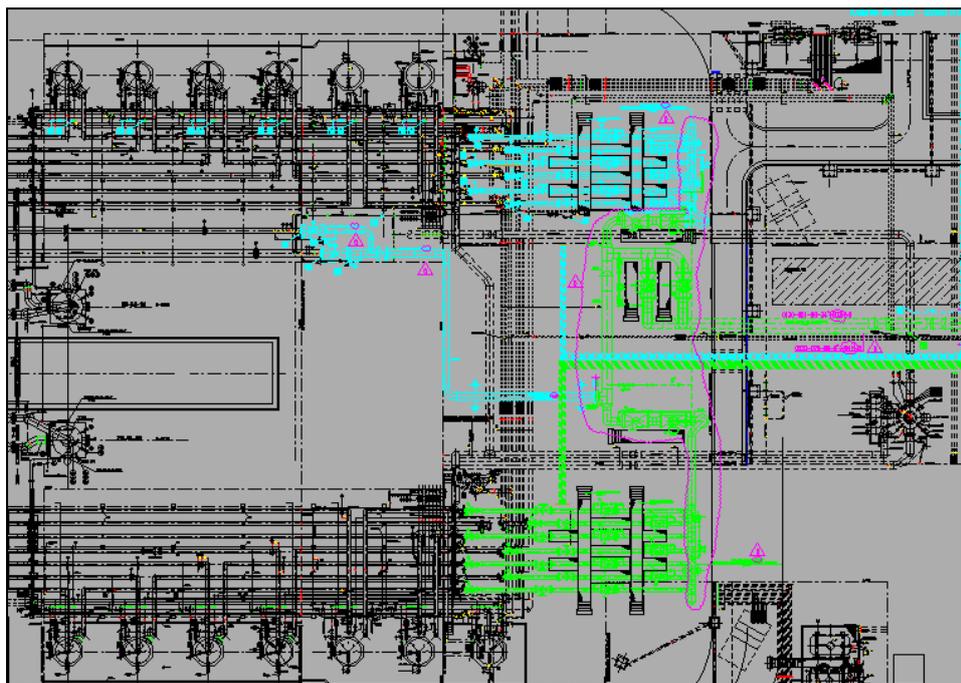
Planimetria Tie-ins di Centrale – Fase 1 + Fase 2 (in ciano nuove installazioni Fase 2, in verde nuove installazioni Fase 1)
